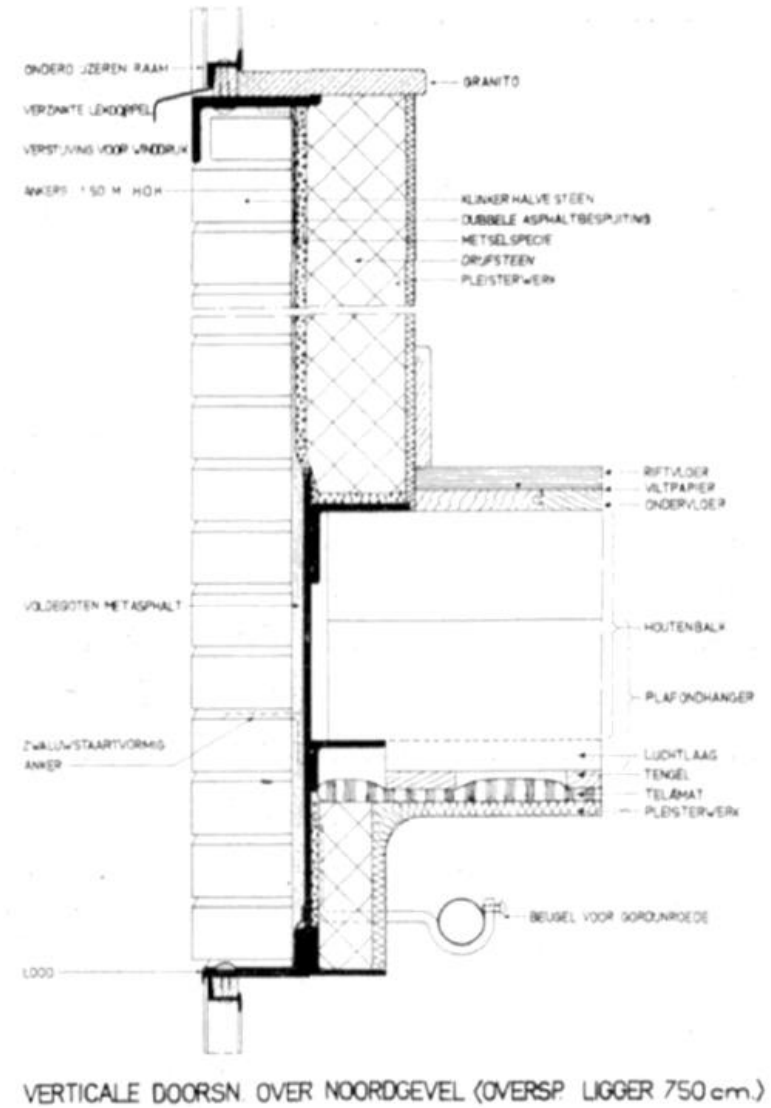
Detalle constructivo. Fuente: Bouwkundig\_weekblad\_Architectura 56E Jaargang 1935
